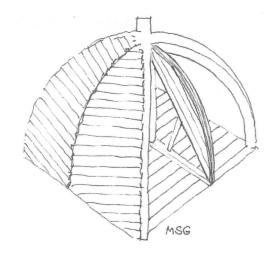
Forma de construcción de la bóveda de la torre de San Millán de Segovia
